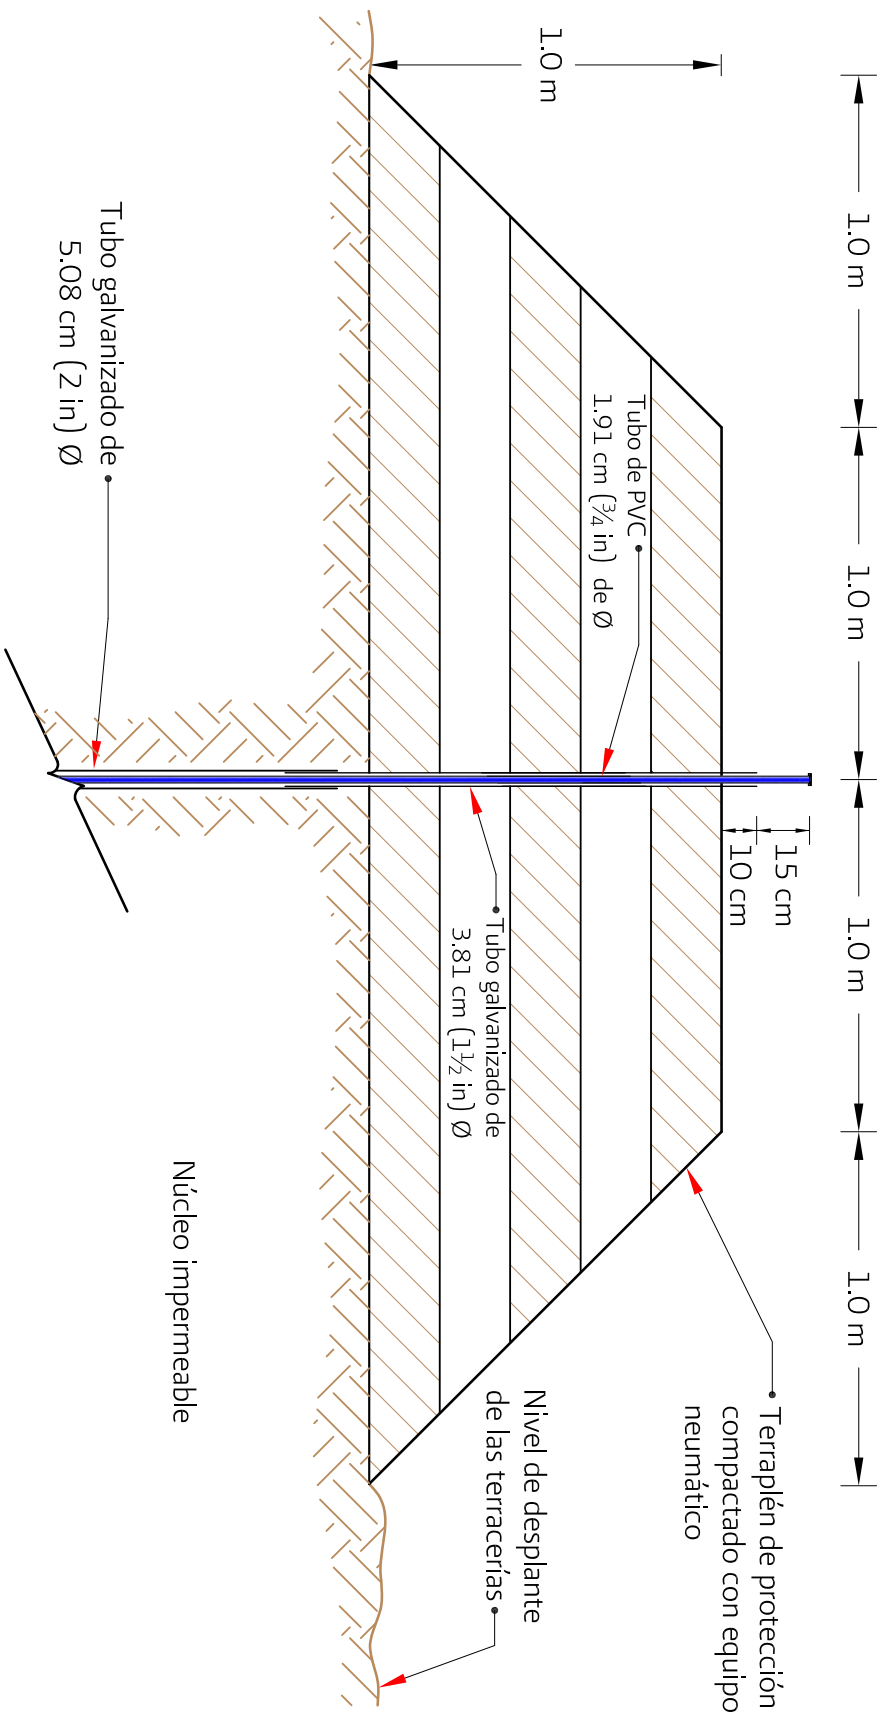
Terraplén para protección de tubería de piezómetro abierto, instalado en núcleo impermeable
